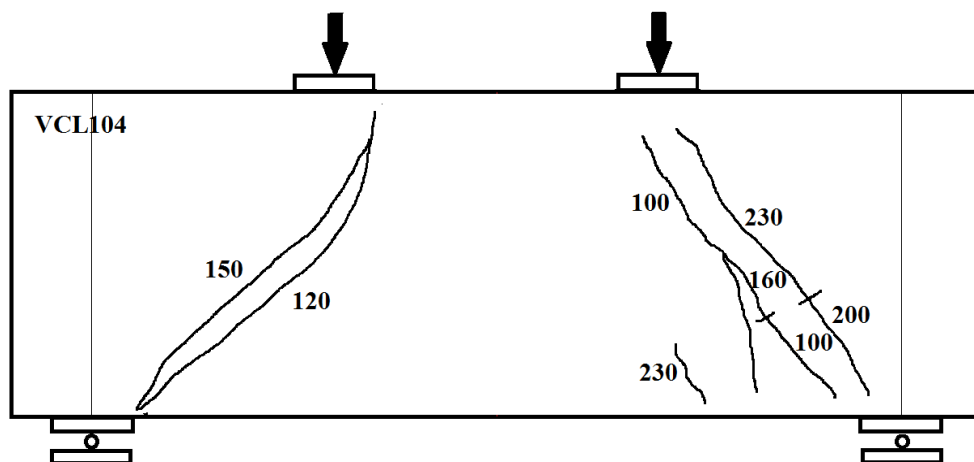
Esquema de fissuração da viga VCL104.
